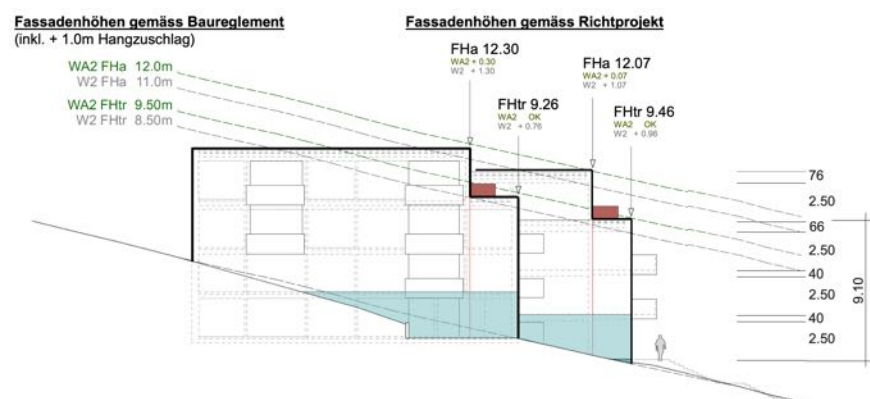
Veranschaulichung der Fassadenhöhe in der 2. Bebauungsreihe. Zum Vergleich die Fassadenhöhe (FHtr / FHa) gem. WA2 / W2.
